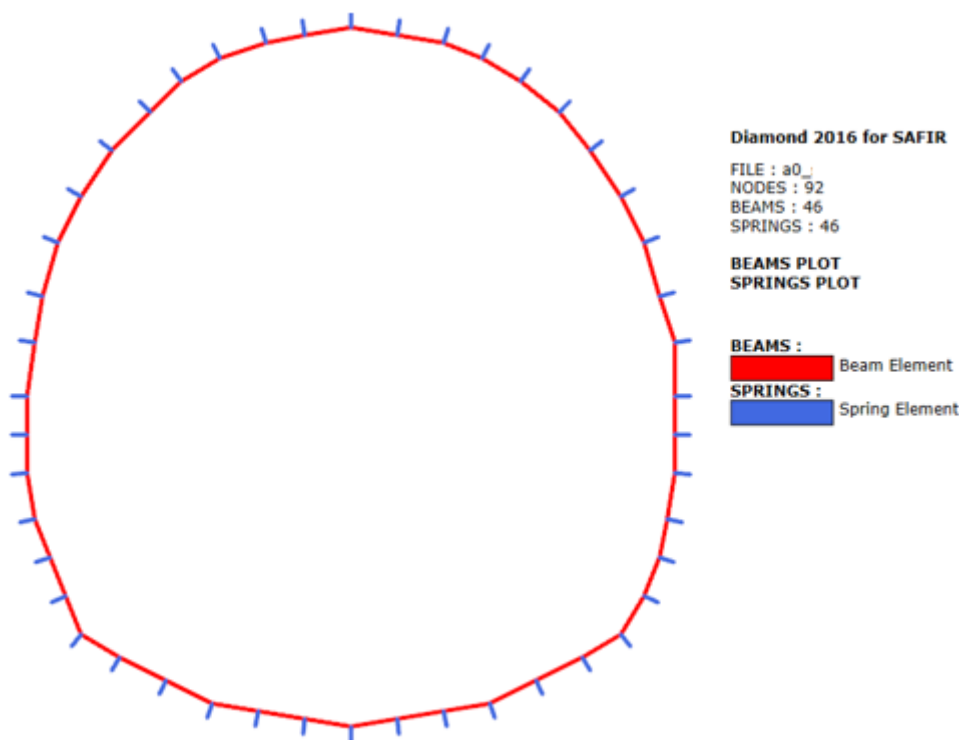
Sezione A0 rappresentata tramite elementi 'beam'
